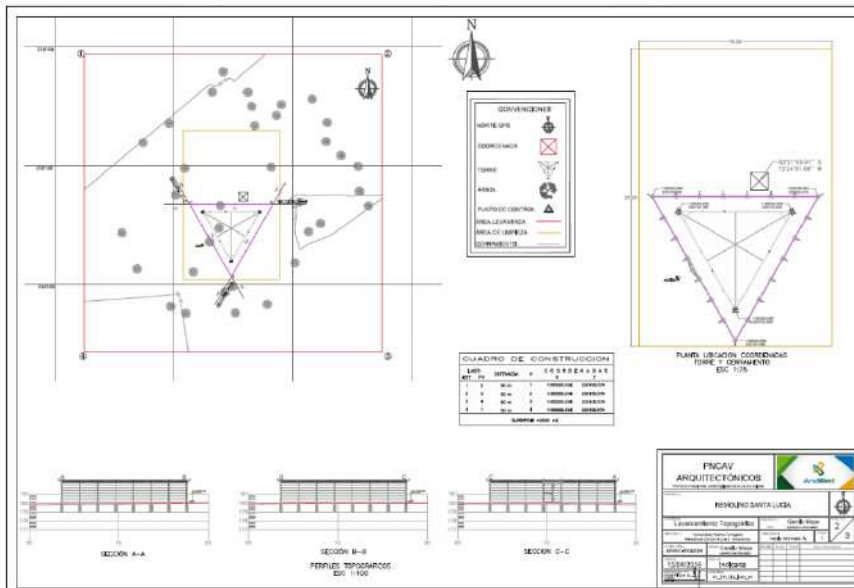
Planos Arquitectónicos perfil de la torre “Remolino Santa Lucia”
